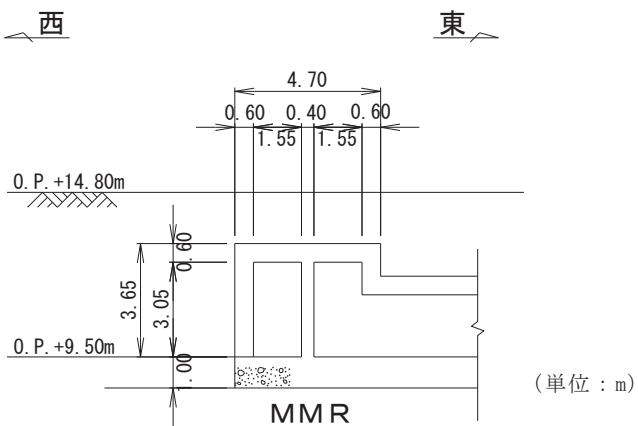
軽油タンク連絡ダクト断面図（B-B 断面，接続部）
